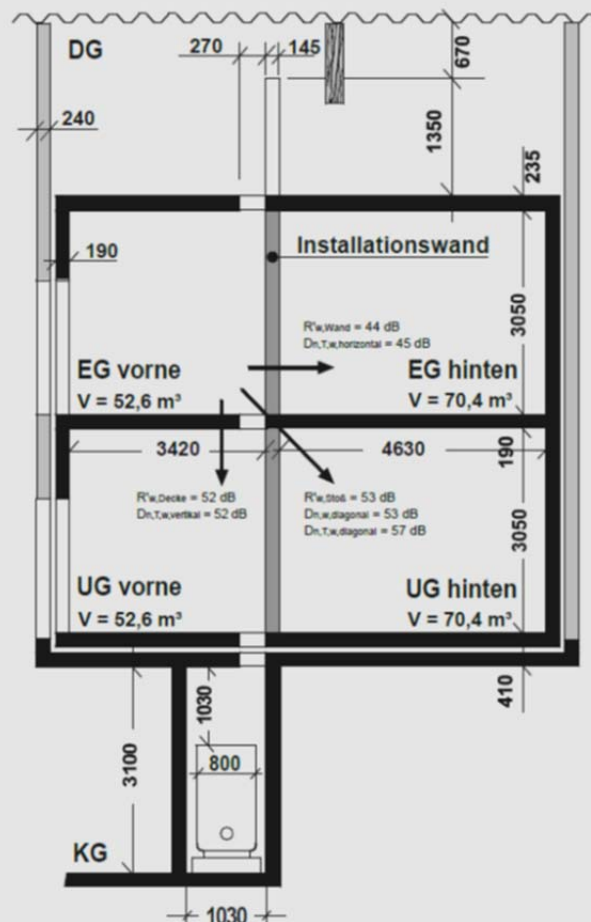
Schnittzeichnung des Installationsprüfstands im Fraunhofer-Institut für Bauphysik (Maßangaben in mm). Der Prüfstand besteht aus je zwei übereinanderliegenden Räumen im Erd- und Untergeschoss (EG und UG), so dass in Verbindung mit Dach- und Kellergeschoss (DG und KG) auch über mehrere Stockwerke reichende Installationen, wie z. B. Abwassersysteme, geprüft werden können. Die beiden Installationswände (11,5 cm Kalksandstein-Vollsteine (KSV), beidseitig verputzt) können nach Bedarf ausgetauscht werden. Im Normalfall werden einschalige Massivwände mit einer Flächenmasse von 220 kg/m² nach DIN 4109 verwendet. Da die Schalldämmung dieser Wände nicht den Anforderungen an eine Wohnungstrennwand ($R'_{w} \geq 53$ dB) genügt, befinden sich die nächstgelegenen schutzbedürftigen Räume bei üblicher Grundrissgestaltung diagonal über oder unter dem Installationsraum. Durch seine zweischalige, Körperschallisolierte Bauweise ist der Installationsprüfstand speziell für die Messung niedriger Schalldruckpegel geeignet. Die Messräume sind so gestaltet, dass die Nachhallzeiten im untersuchten Frequenzbereich zwischen 1 und 2 s liegen. Die Decke sowie die seitlich flankierenden Bauteile, mit einer mittleren flächenbezogenen Masse von etwa 440 kg/m², bestehen aus 19 cm Stahlbeton.
